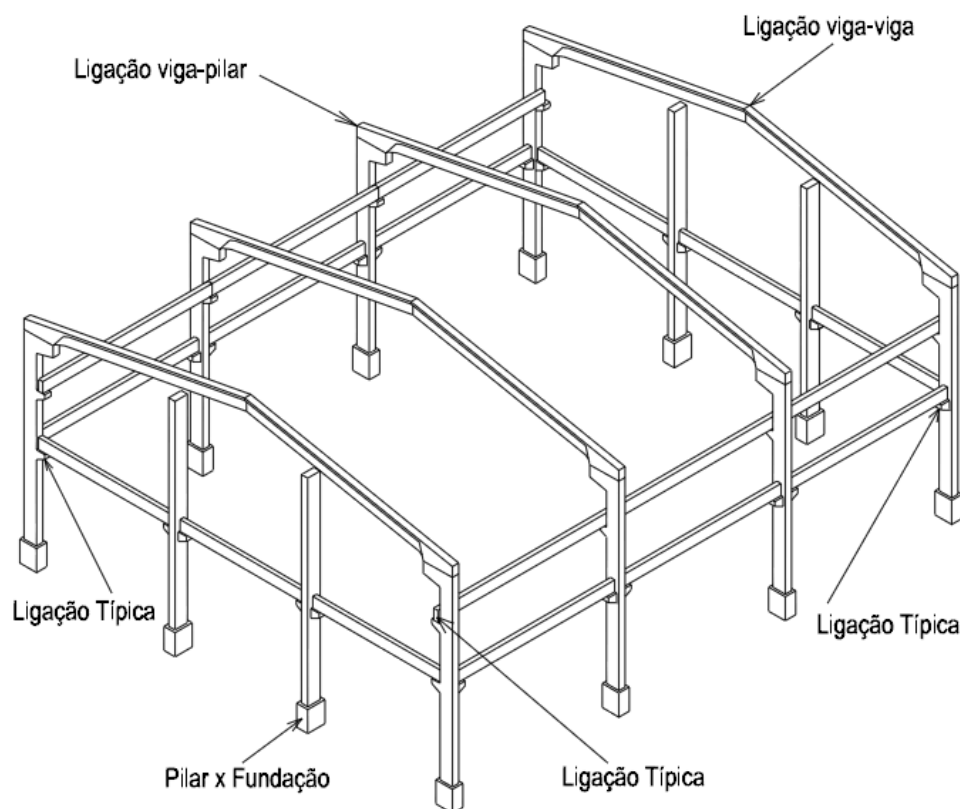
Tipos de ligações entre os elementos estruturais. Fonte: SANTOS (2010)
